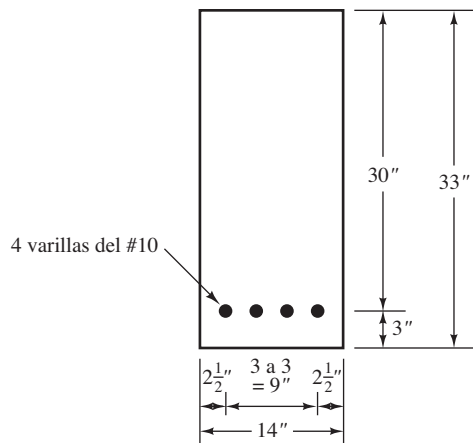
Sección final transversal para el Ejemplo 4.3
